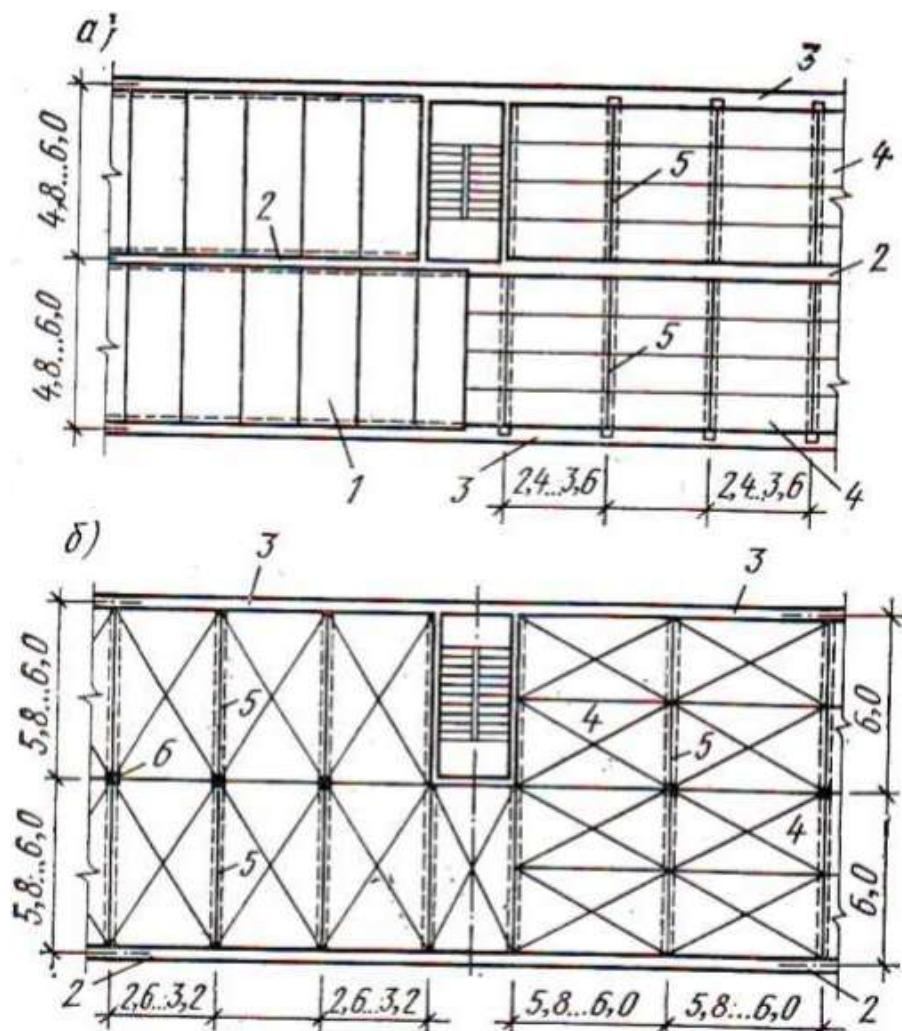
Конструктивные схемы плитных перекрытий: а) с продольными линиями опор, б) с поперечными линиями опор. 1 - панели перекрытия, опирающиеся на несущие стены, 2 - внутренняя продольная стена, 3 - наружная несущая стена, 4 - панели перекрытия, опирающиеся на прогон, 5 - прогон (балка), 6 - колонны
